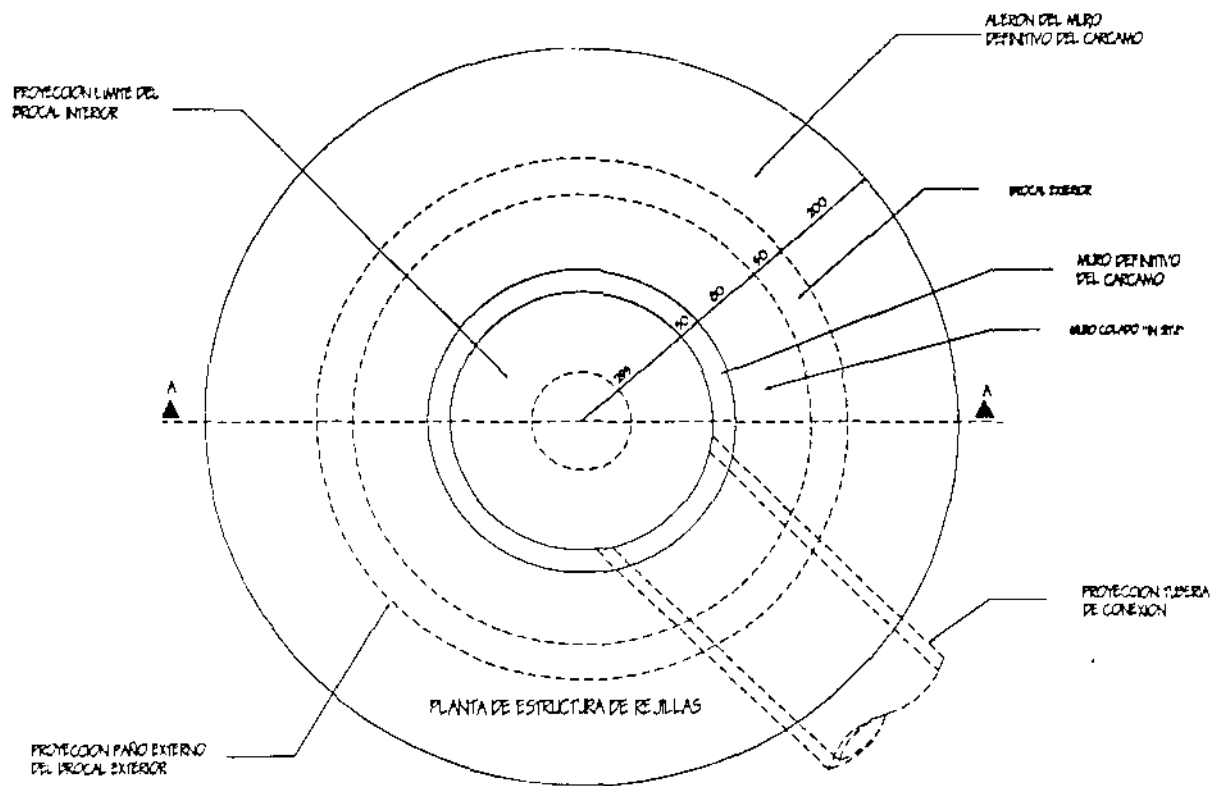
PLANTA GENERAL DE CARCAMO COLADO "IN SITU"
